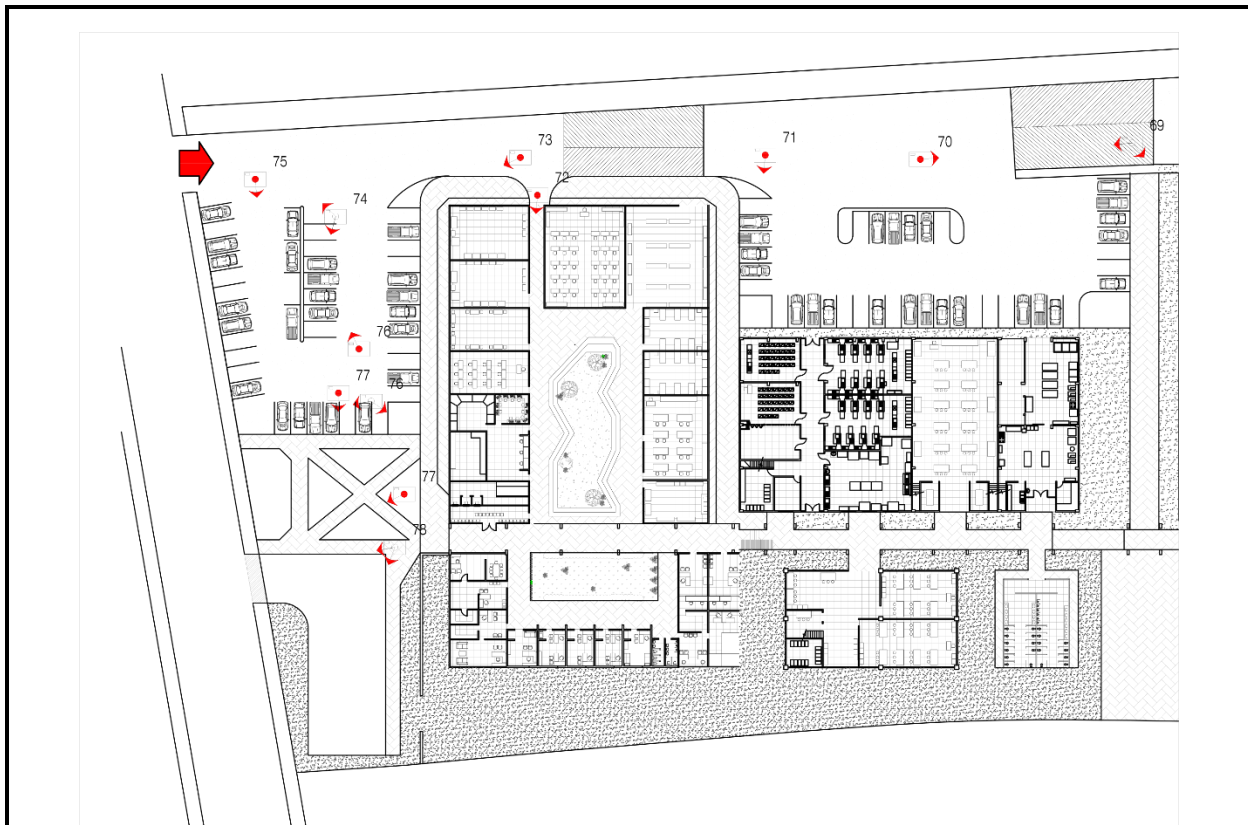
PLANTA DE SEGUNDO SECTOR DE PARQUEOS
